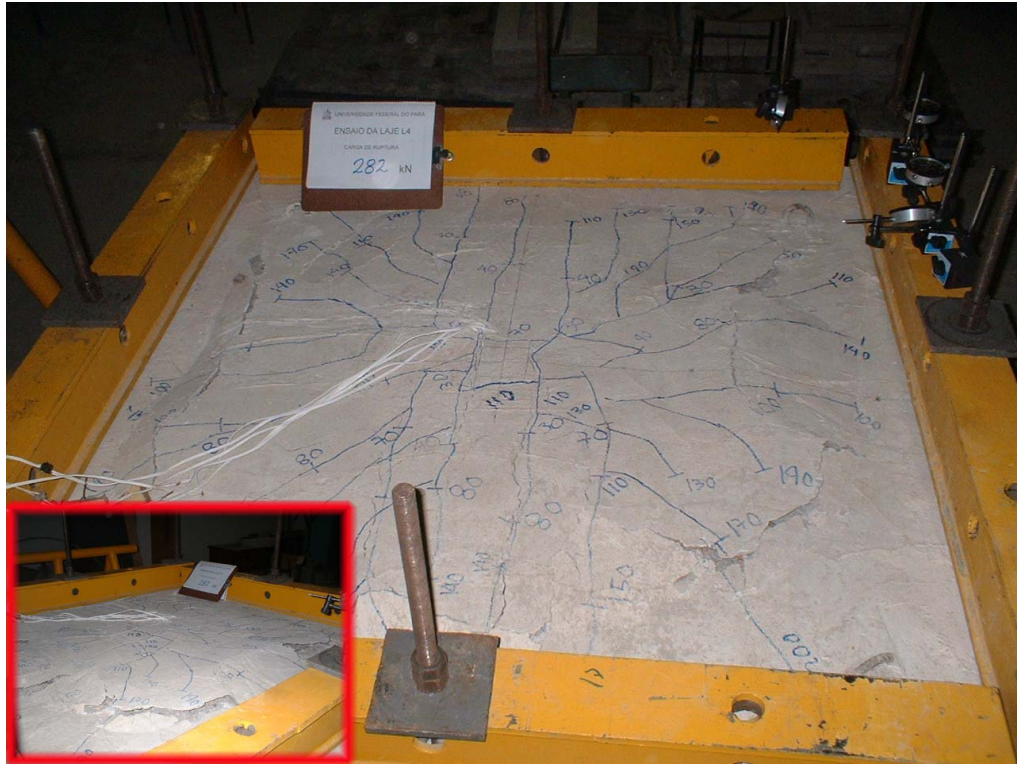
Fissuras desenvolvidas na face superior da laje L4
